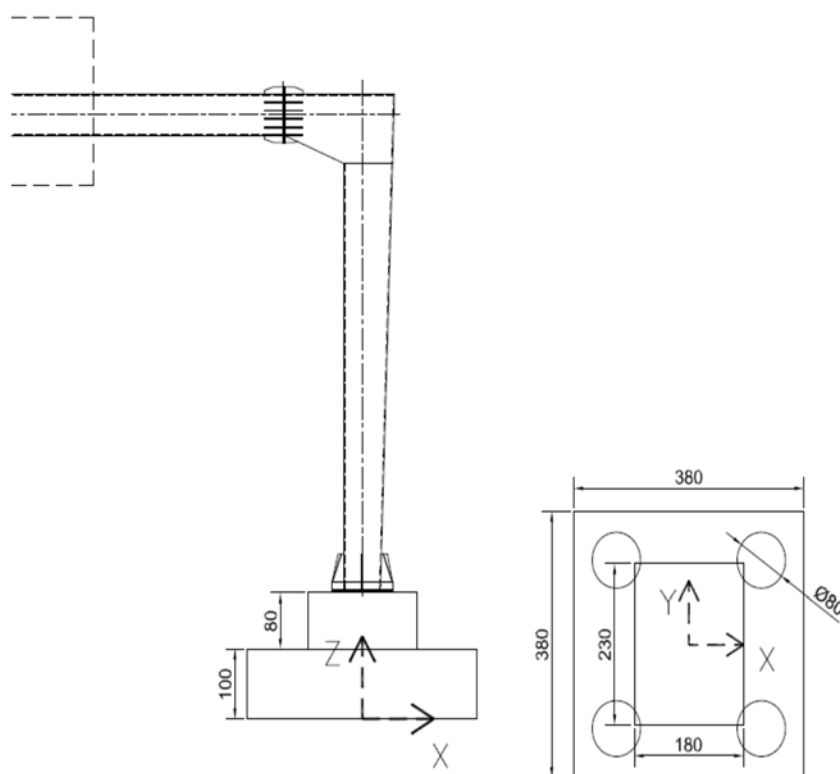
Carpenteria del plinto di fondazione - Posa su terreno pianeggiante
